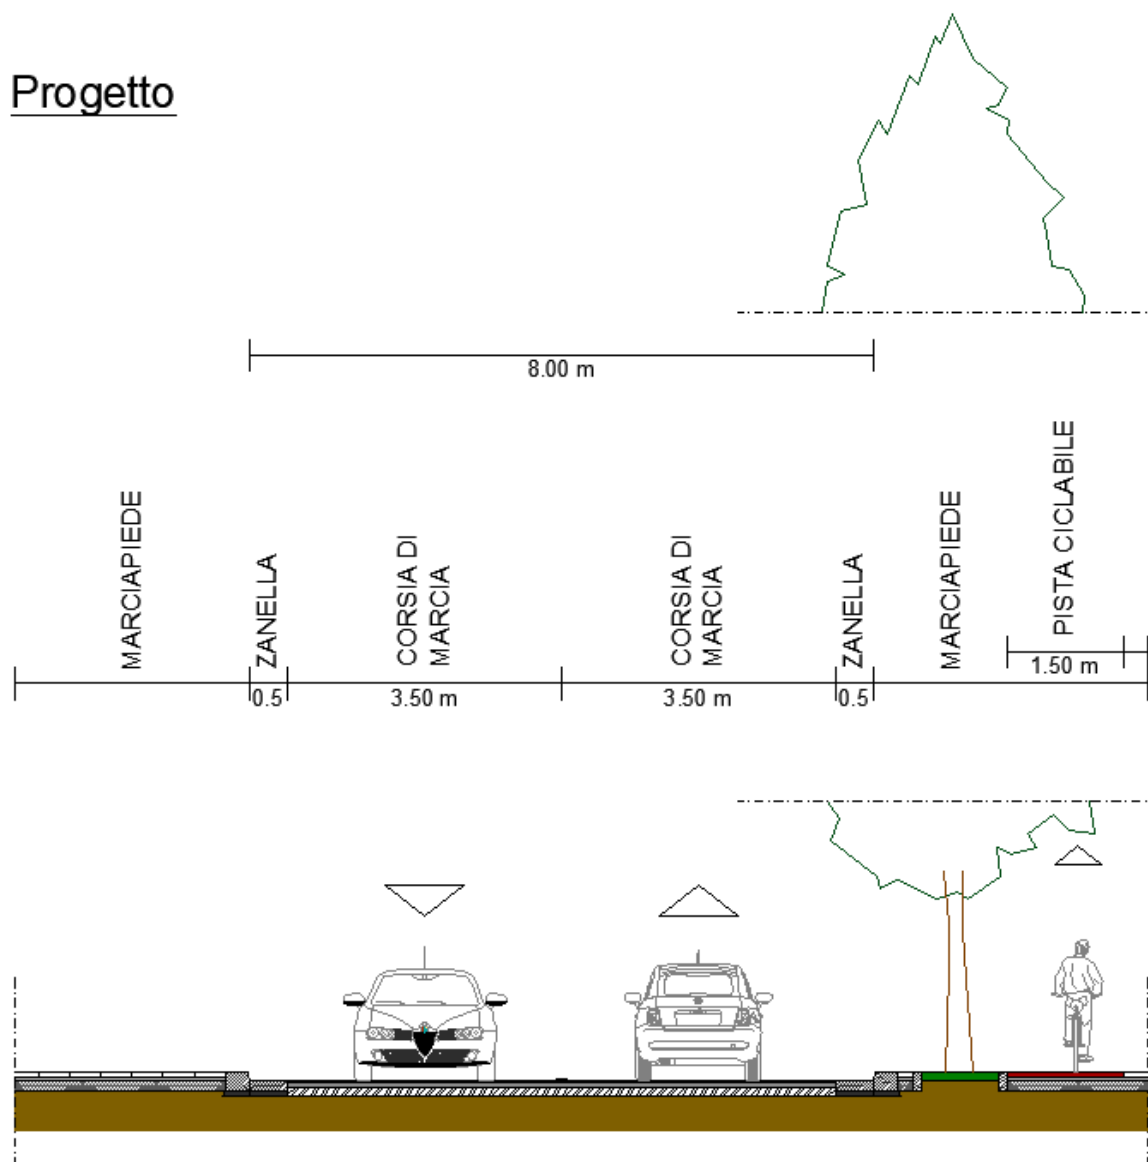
via Terracina, sezione trasversale di progetto (tratto iniziale di 650 m).
